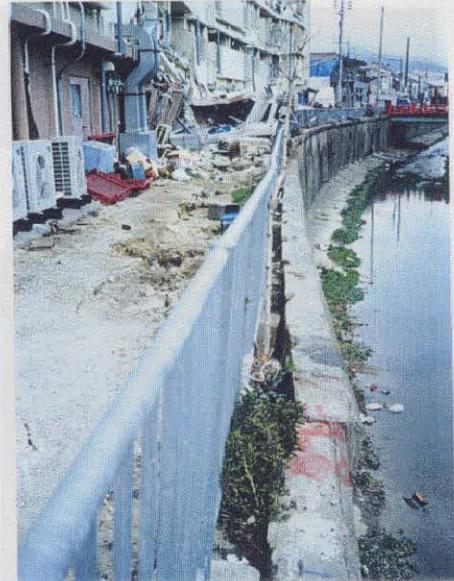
(図-8.3.1の⑤) 長田区長田町1丁目付近
